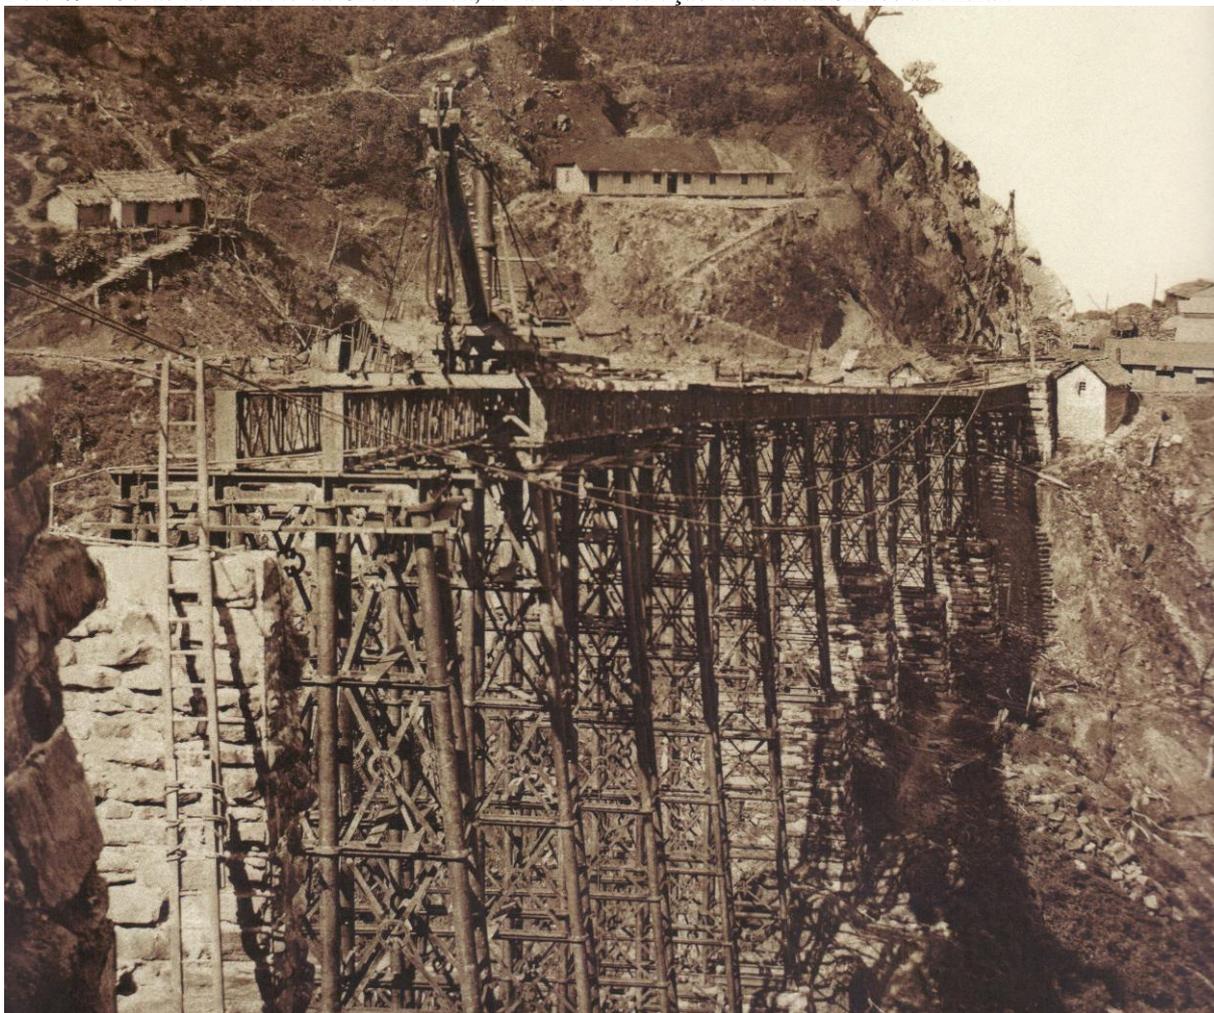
Vista da construção da Ferrovia Santos a Jundiáí.
